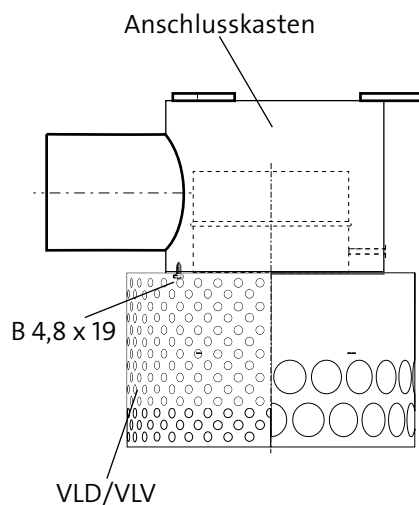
Kanalmontage und Befestigung am Anschlusskasten
